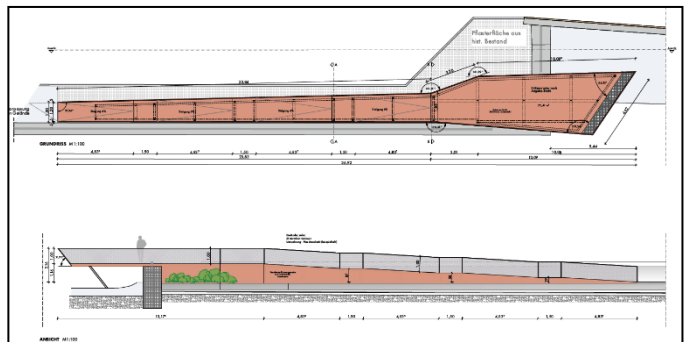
Detailplan Viewpoint Ziegelstraße 01/2021
